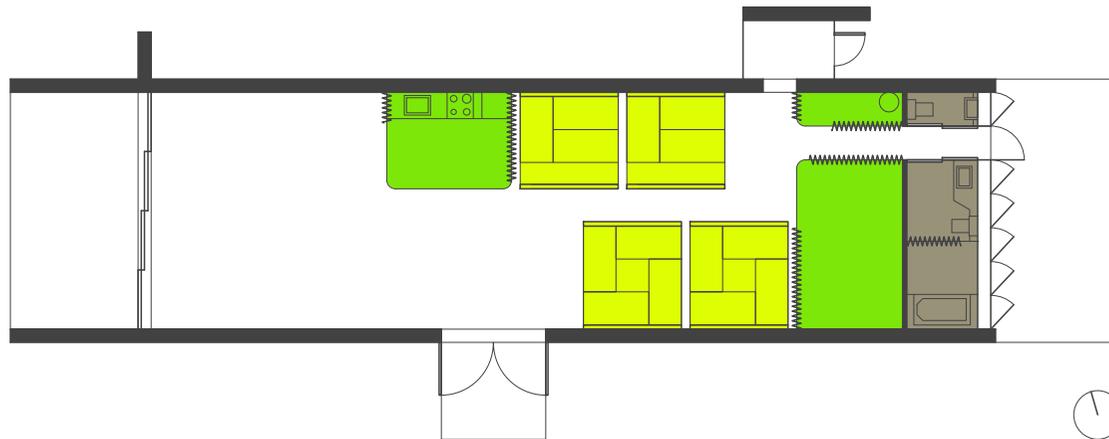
Grundriss „Naked House“, eigene Darstellung
